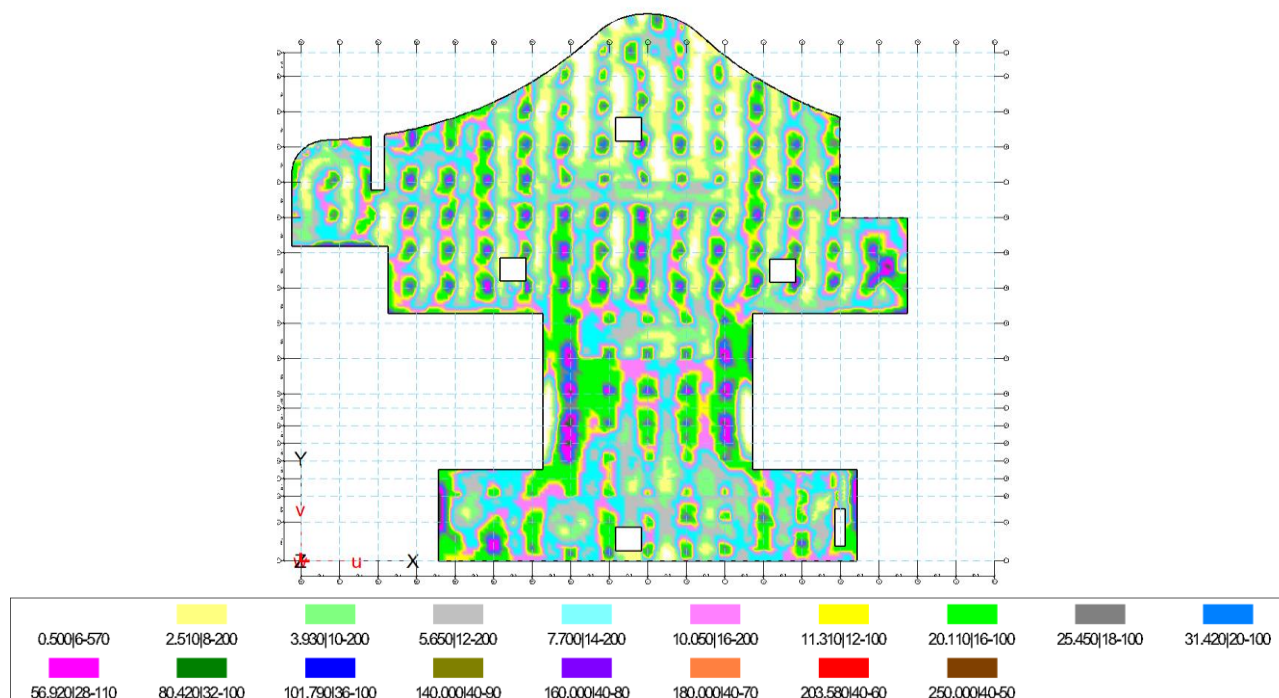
Армирование фундаментной плиты. Верхняя продольная арматура в направлении оси R, см²/м [15]
